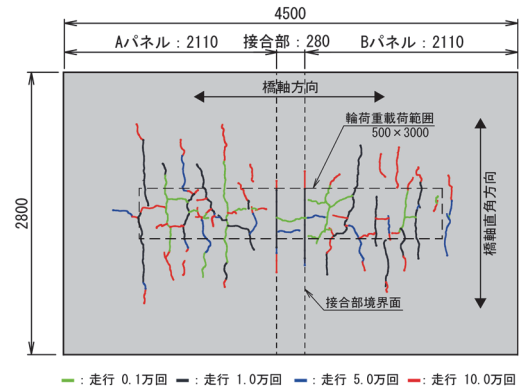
下面ひび割れ発生状況（横目地試験体）³⁾
